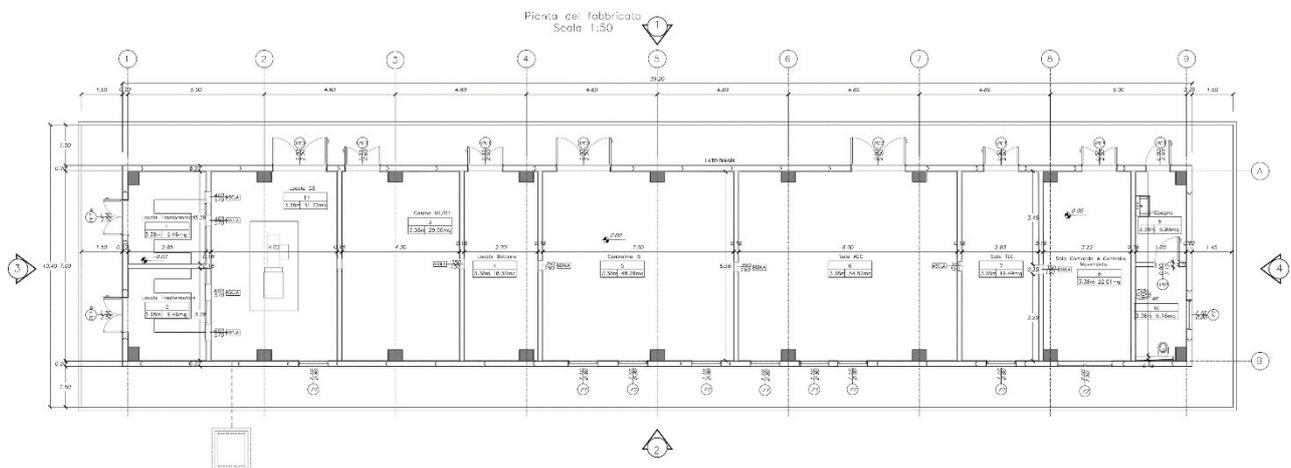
Pianta architettonica – Fabbricato tecnologico
